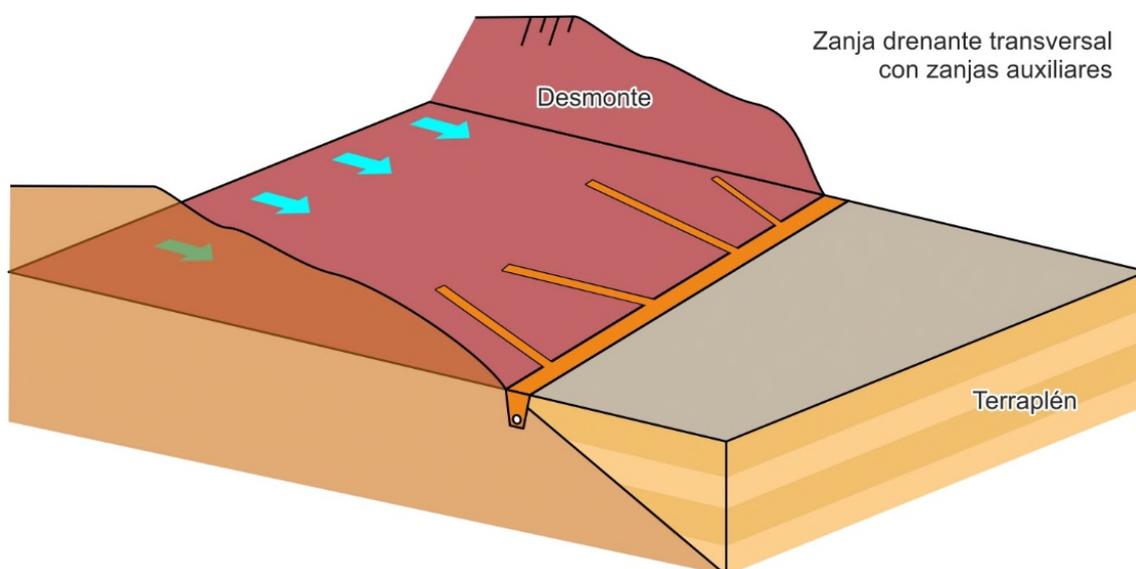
Sistema de zanja transversal en la transición desmante-terraplén, con zanjas auxiliares para drenaje de fondo de desmante de baja permeabilidad
